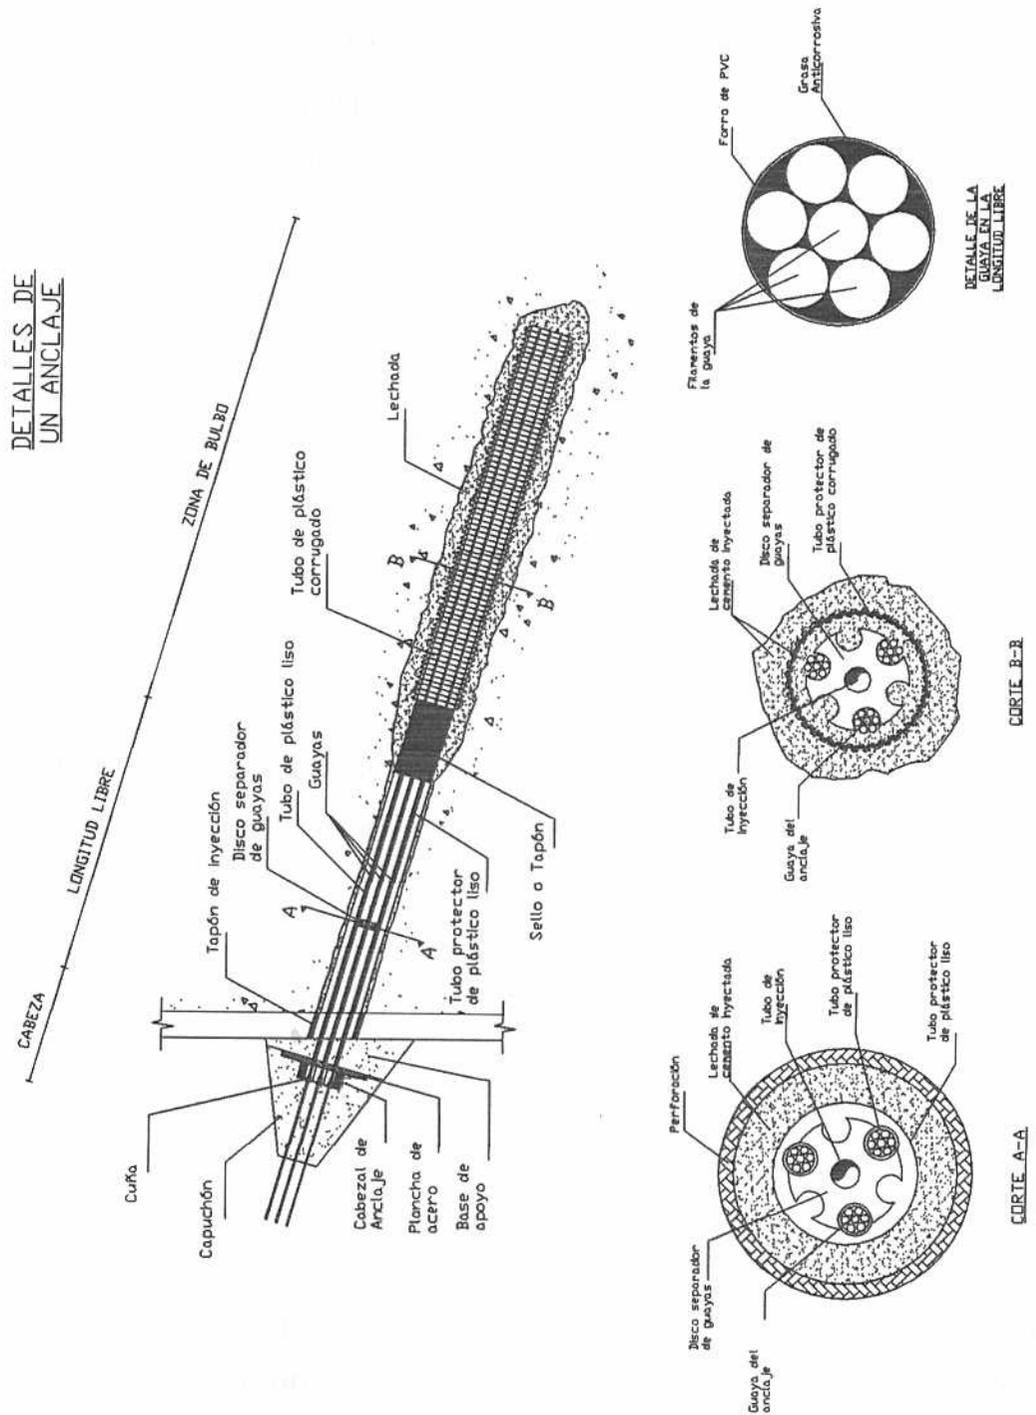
Detalles de un Anclaje. (Centeno Werner, Roberto; 2007)
